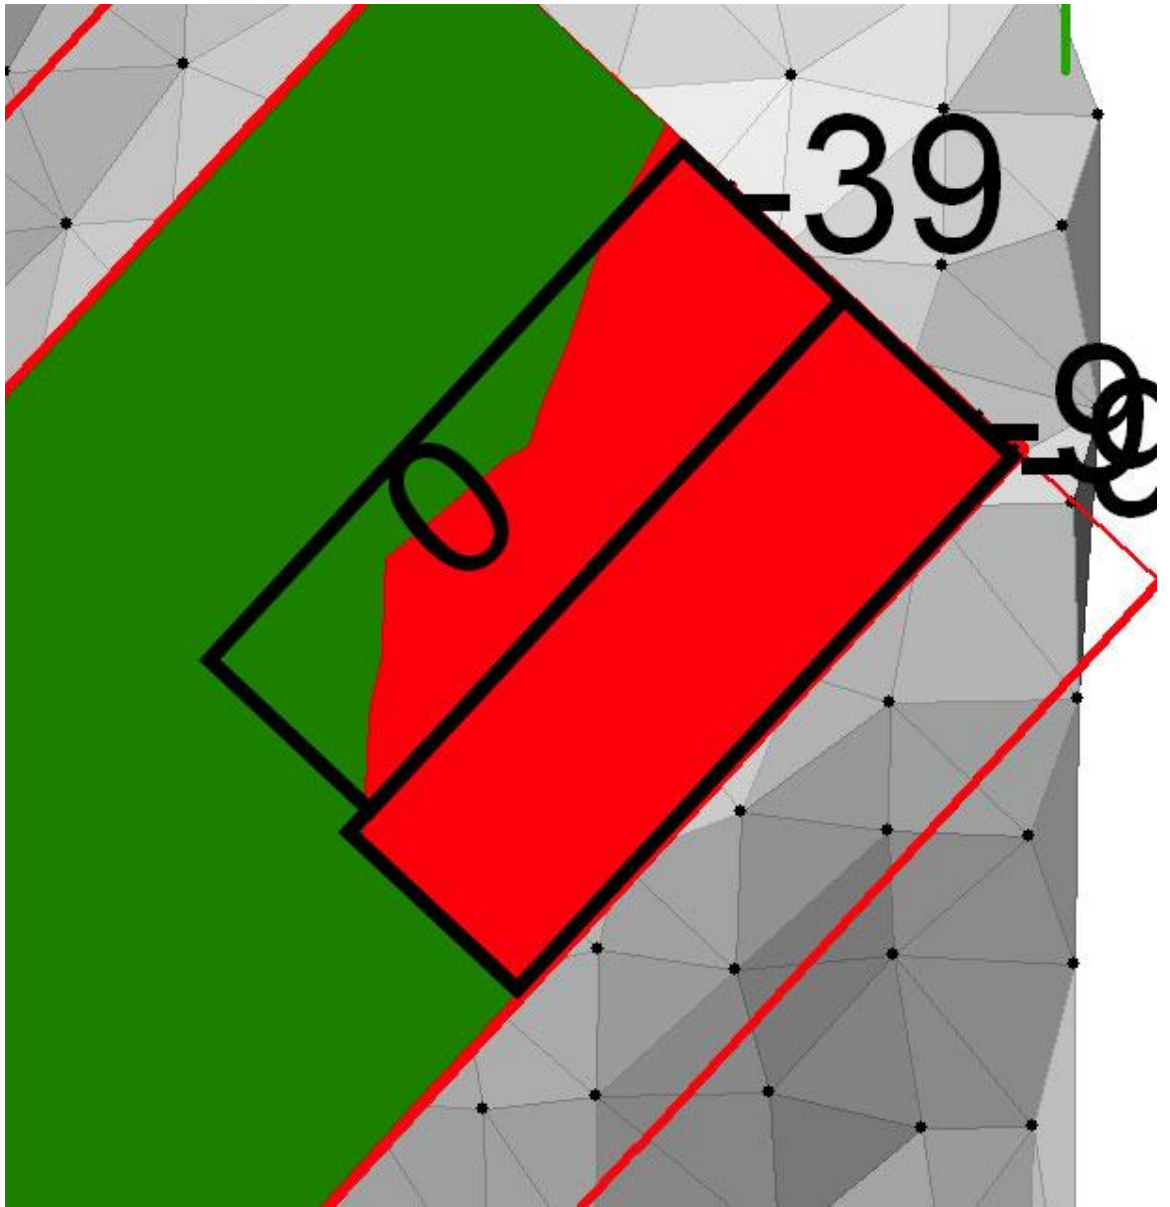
(полосы фрезерования, построенные при движение фрезы относительно направления трассы)
